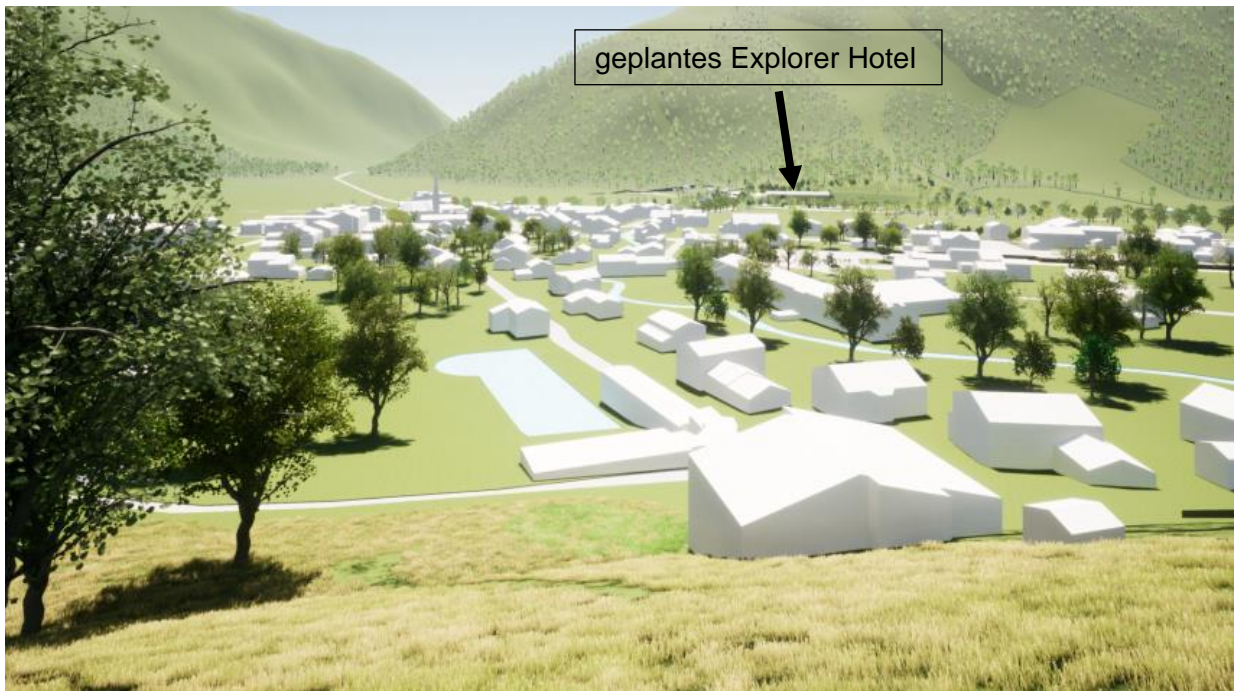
Standortüberprüfung – Perspektive Paraplu, Renn Architekten, 24.06.2022
